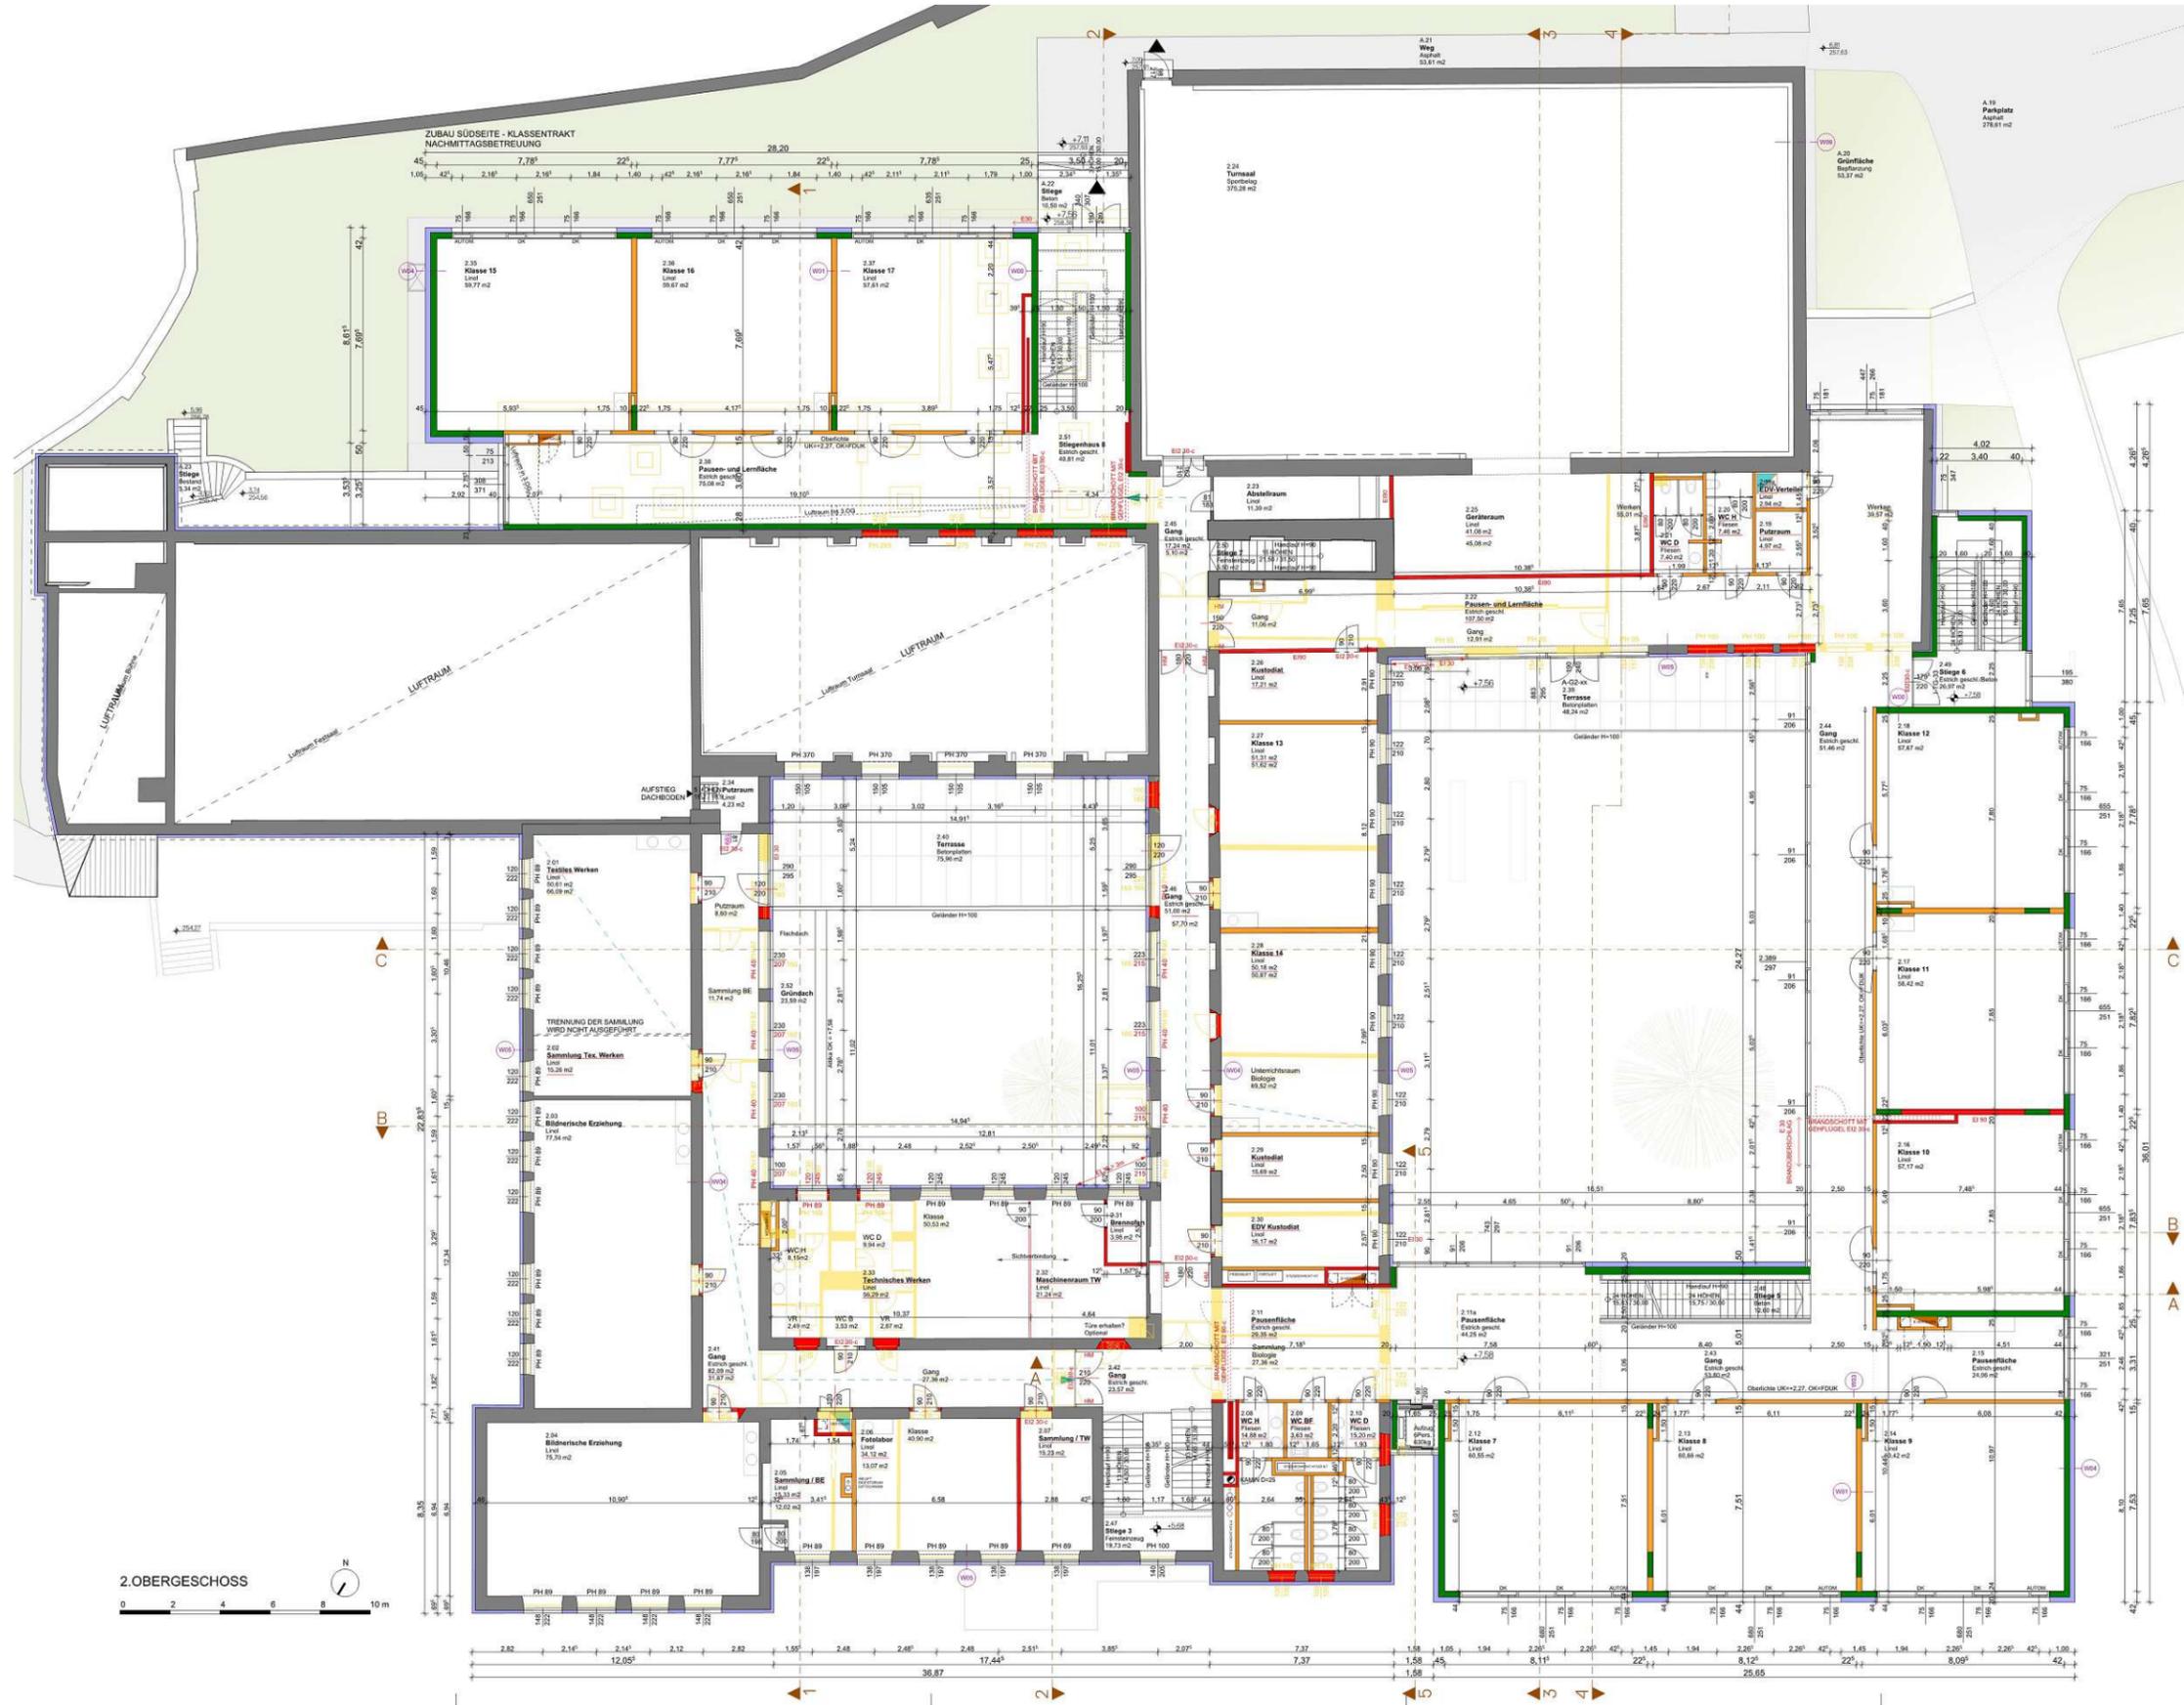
Grundriss 2. Obergeschoss
